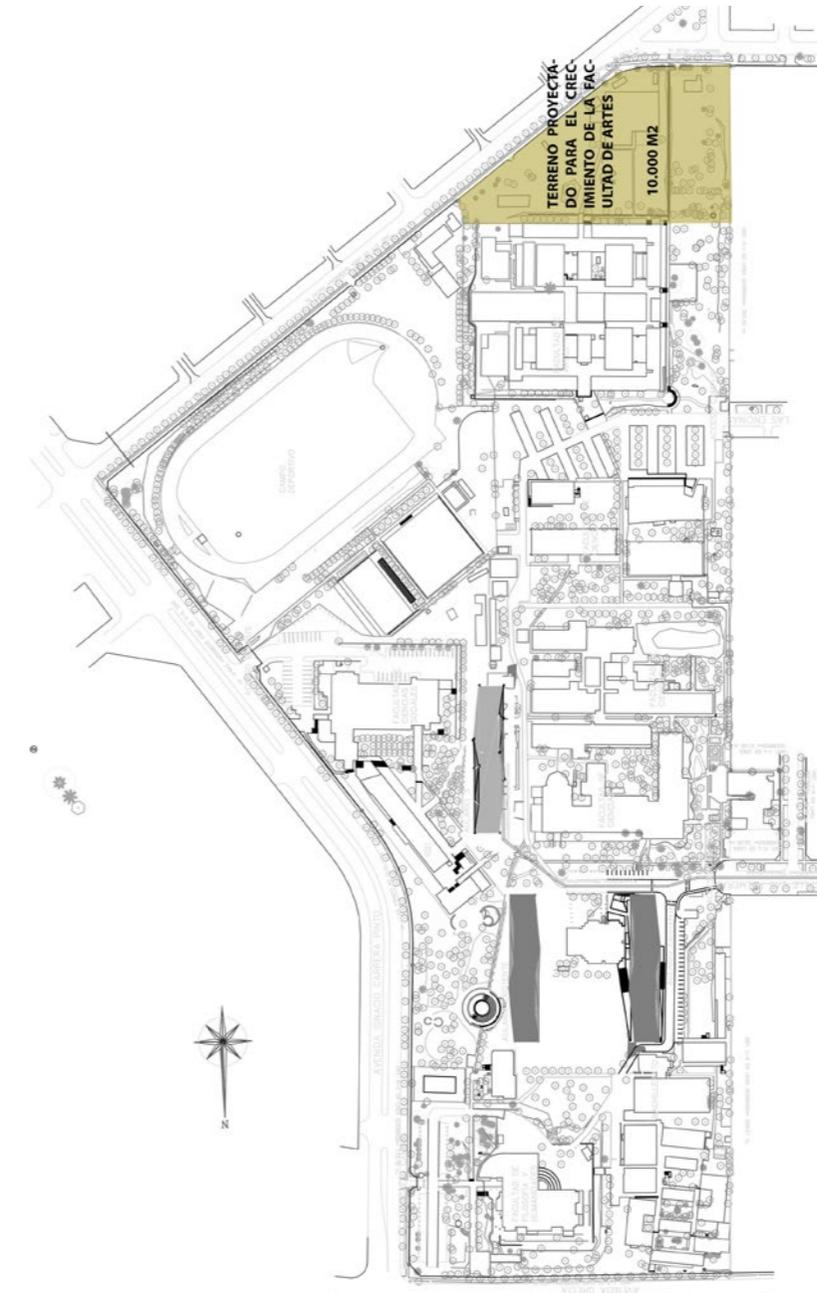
Campus JGM y terreno proyectado para el crecimiento de la Facultad de Artes, actualizado con intervenciones del plan maestro Bicentenario. Fuente: Elaboración propia en base a plano obtenido de MercadoPublico.cl accedido el 10/03/17
